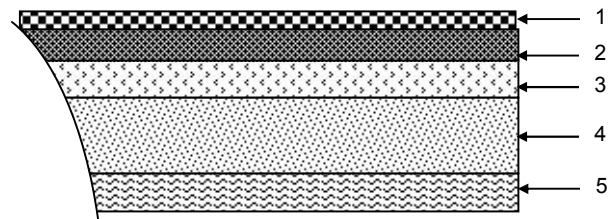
Plancher étage courant (dalle pleine).
